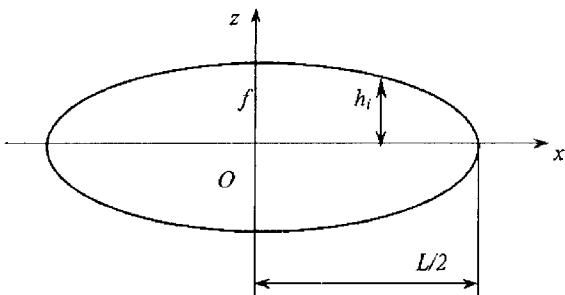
Опалубка для бетонирования монолитного перекрытия со строительным подъемом (фиг. 5., 6)
